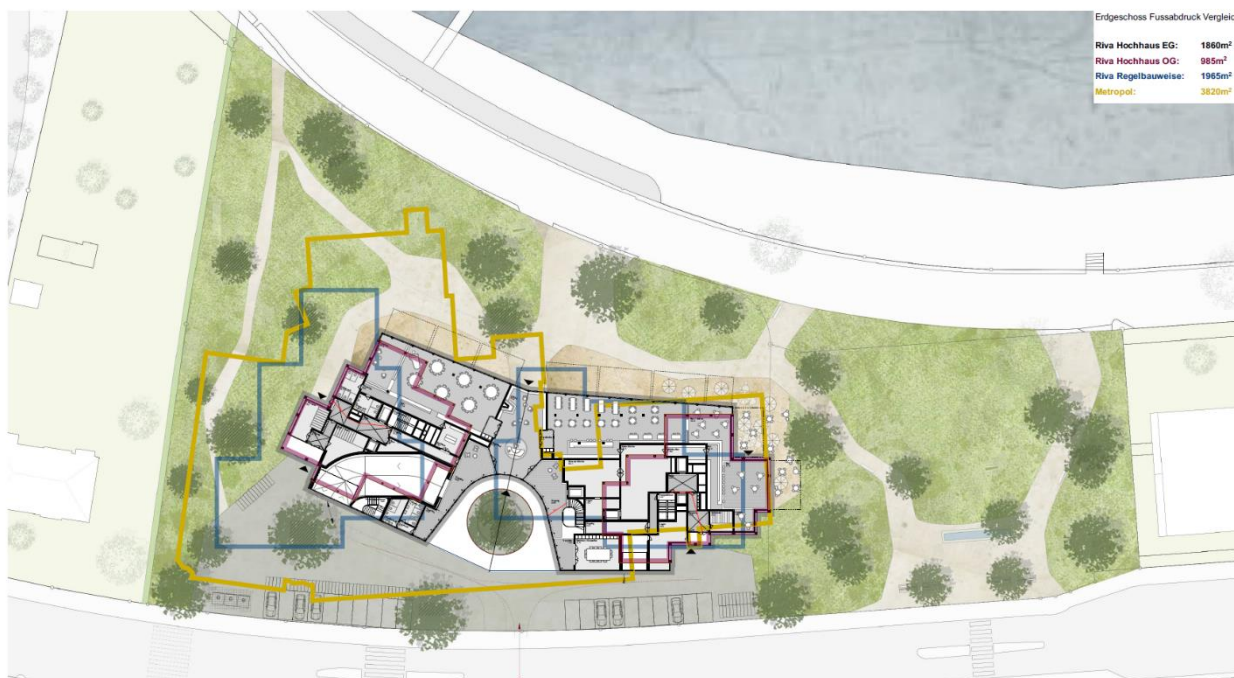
Erdgeschoss Fussabdruck-Vergleich Metropol/Riva/Alternativprojekt
